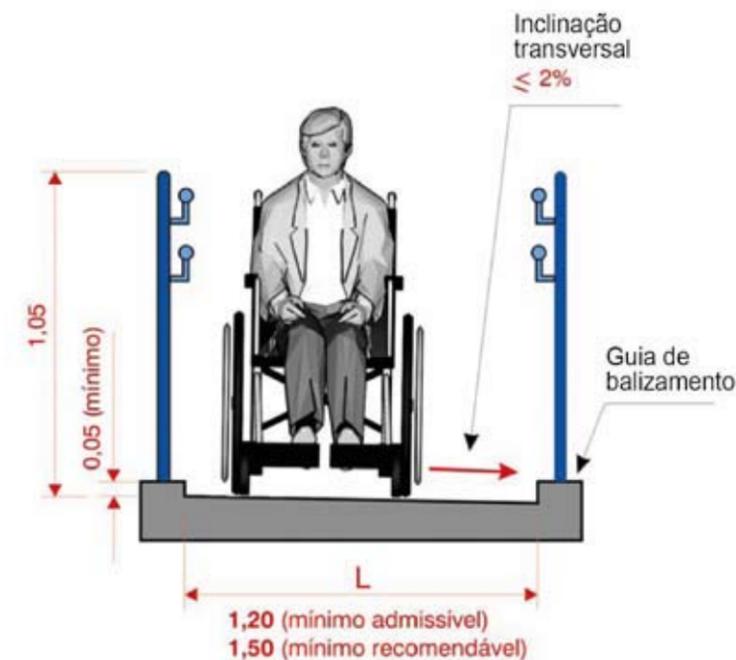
Dimensionamento e inclinação transversal de rampas – Corte frontal
